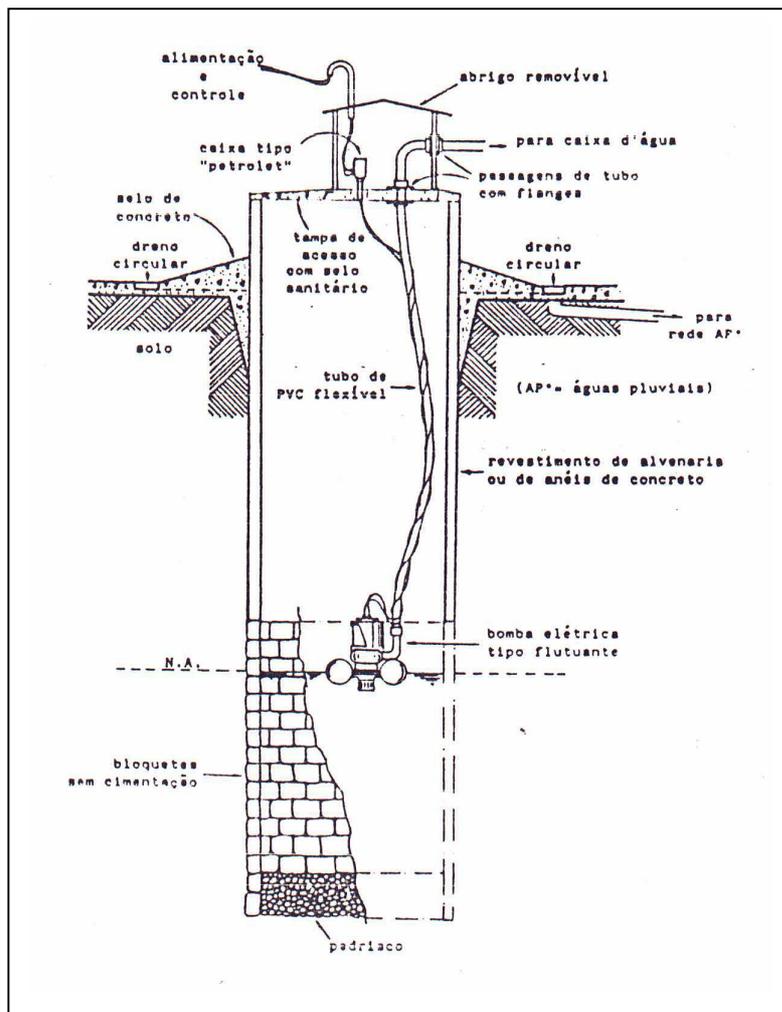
Modelo de ponteira revestida por tubos de alvenaria ou anéis de concreto.
